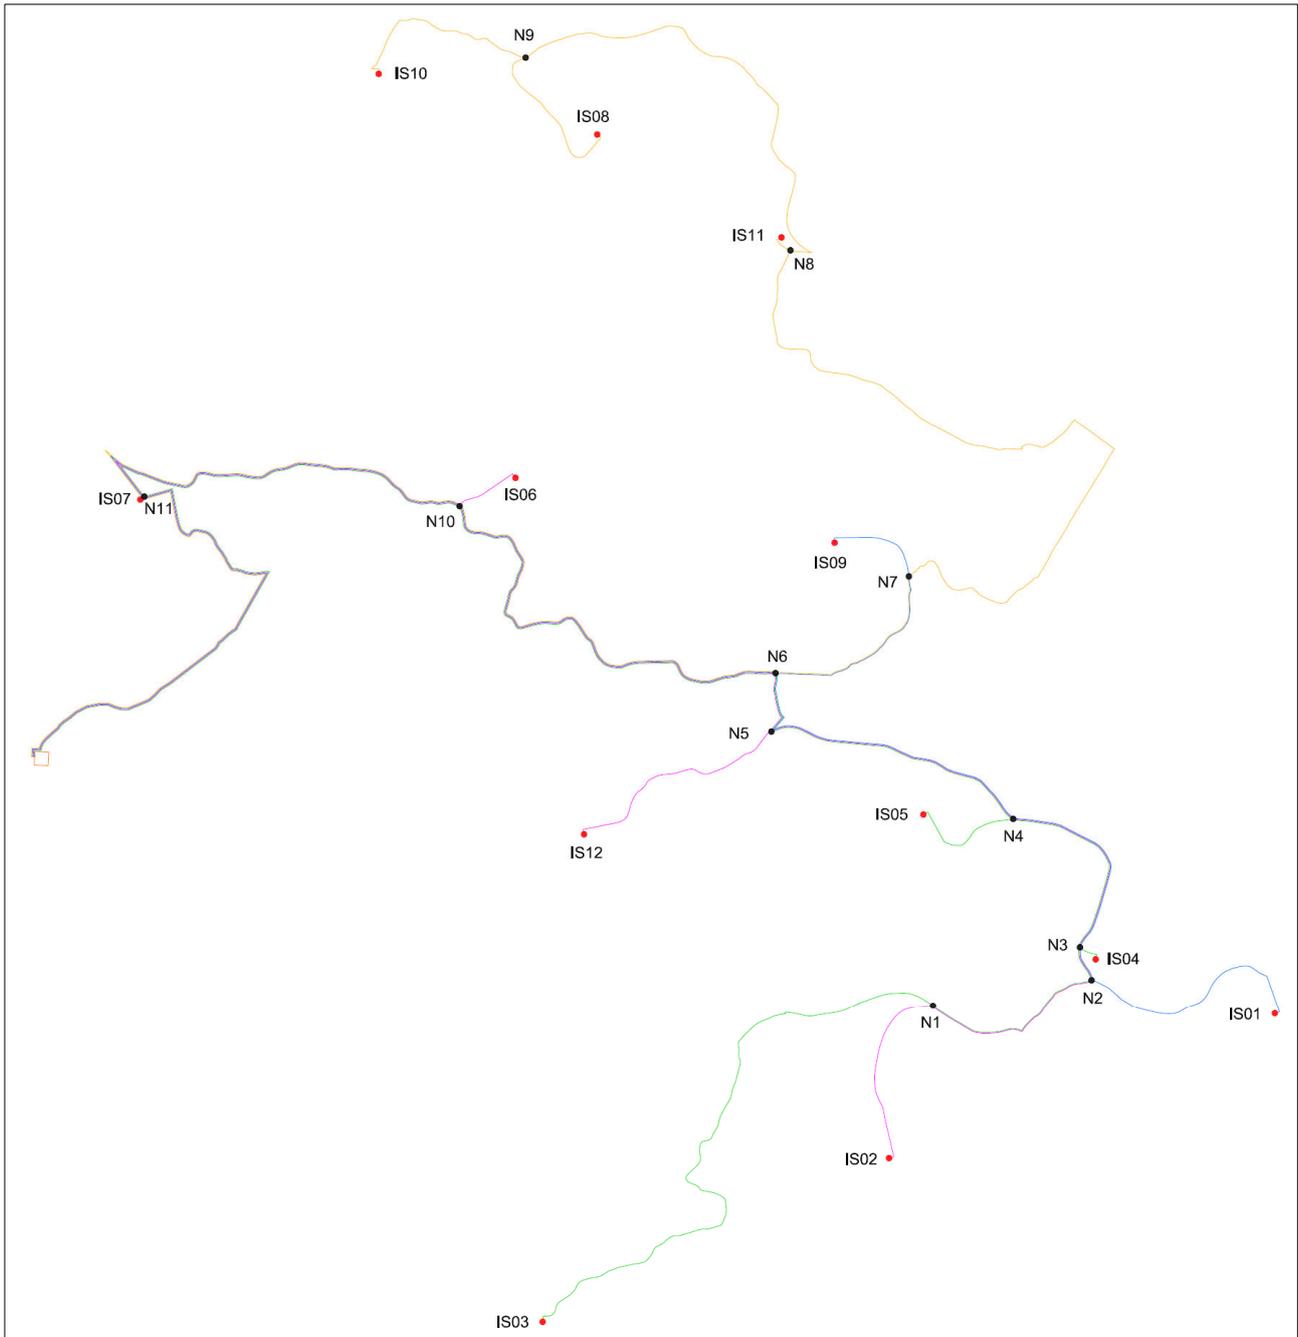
Planimetria generale di distribuzione delle linee a 33 kV
